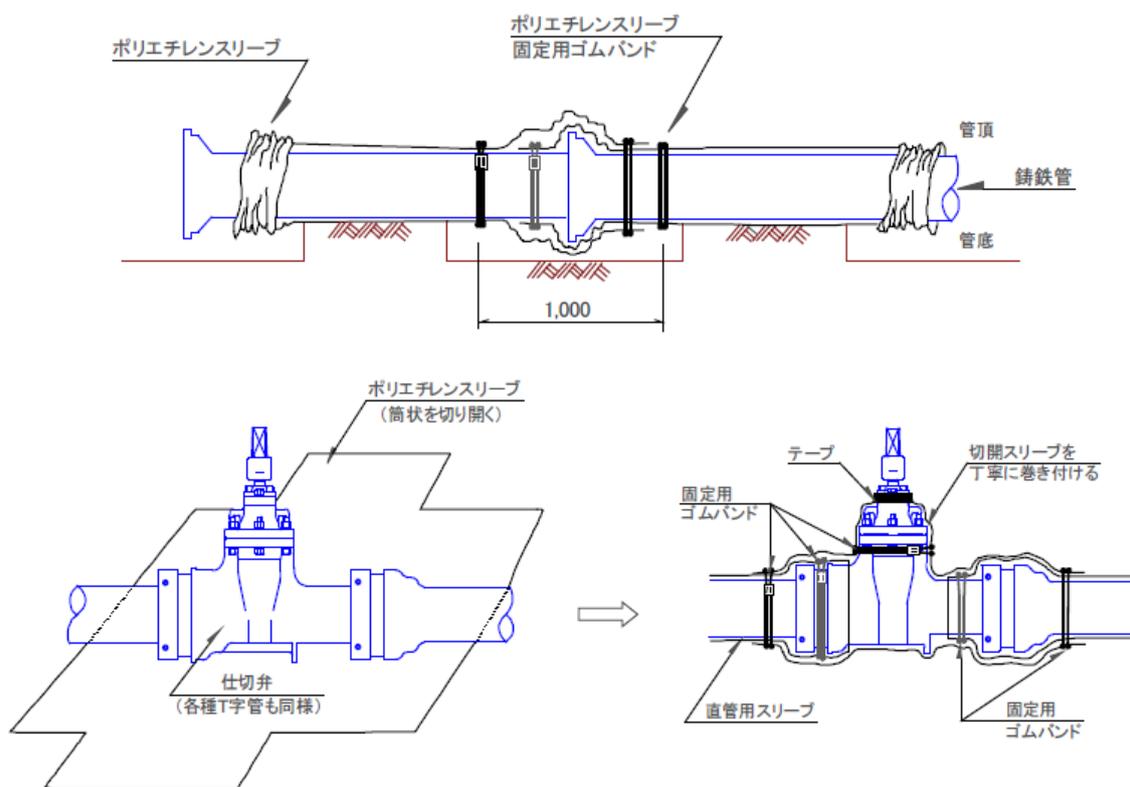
ダクタイル鋳鉄管用ポリエチレンシート被覆参考施工図
